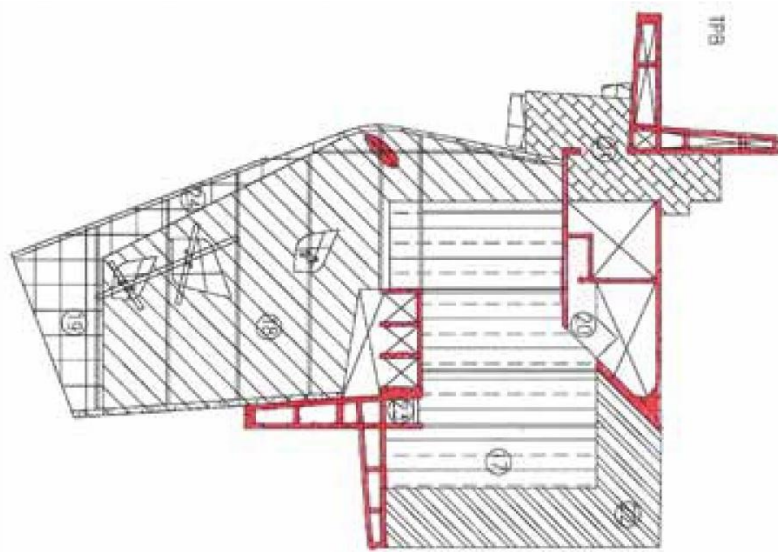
Esquema sobre los diferentes elementos estructurales de la planta mezzanine.
